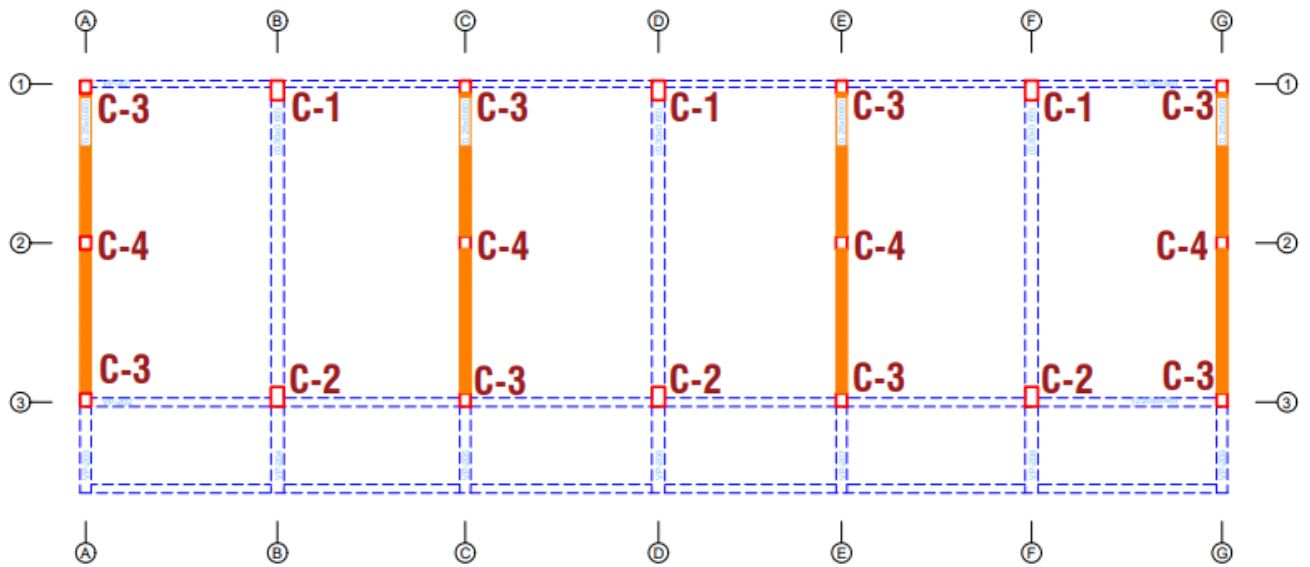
Arranque de acero en columna de confinamiento intermedia Bloque 1
